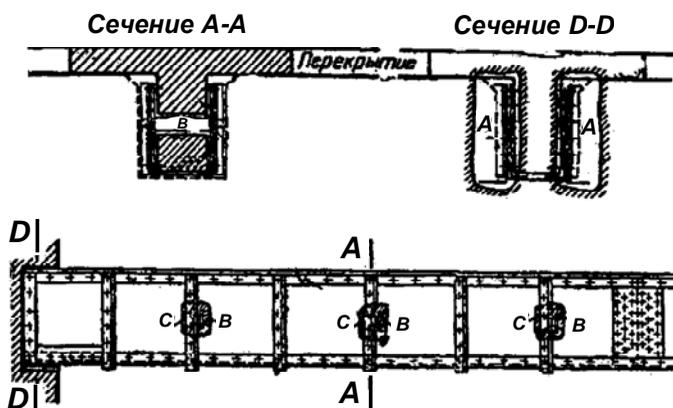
Применение металлических балок со сплошной стенкой для разгрузки перенапряженных железобетонных балок (проф. Мюллер):
